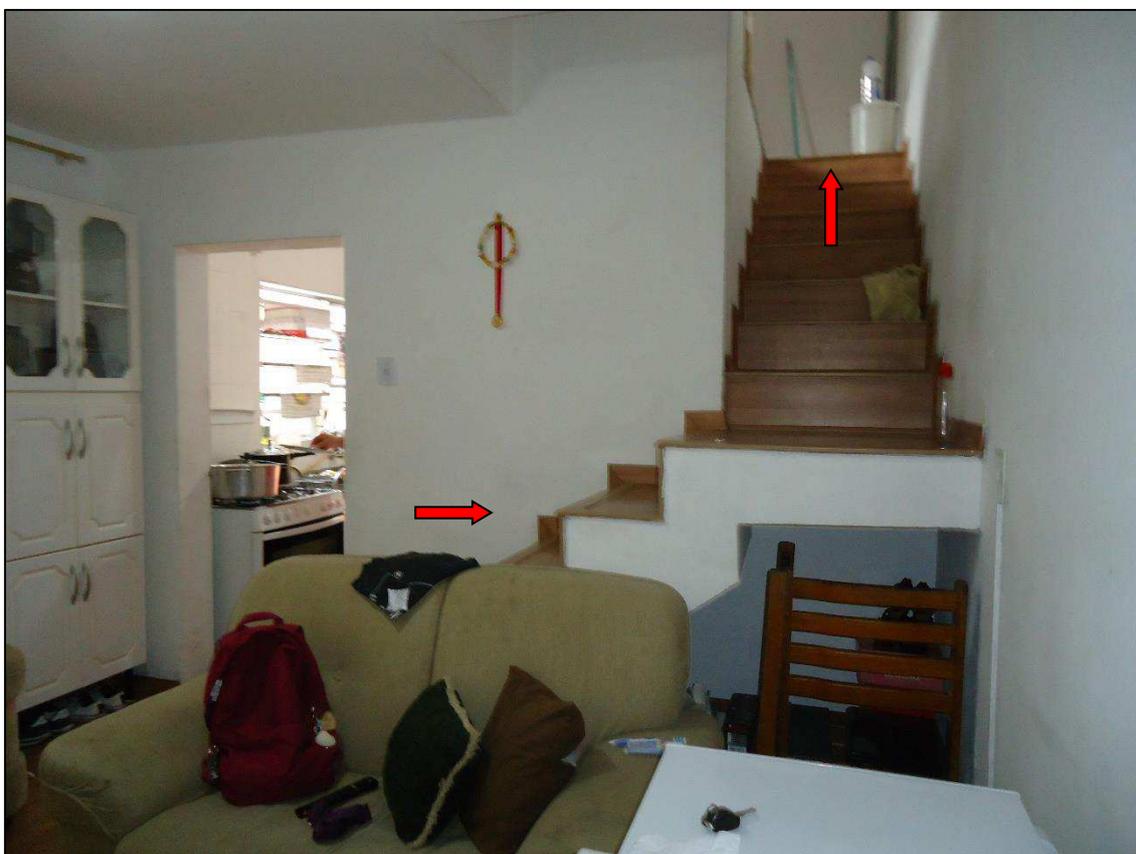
Outra vista da sala e da escada de acesso ao pavimento superior (destacada).
